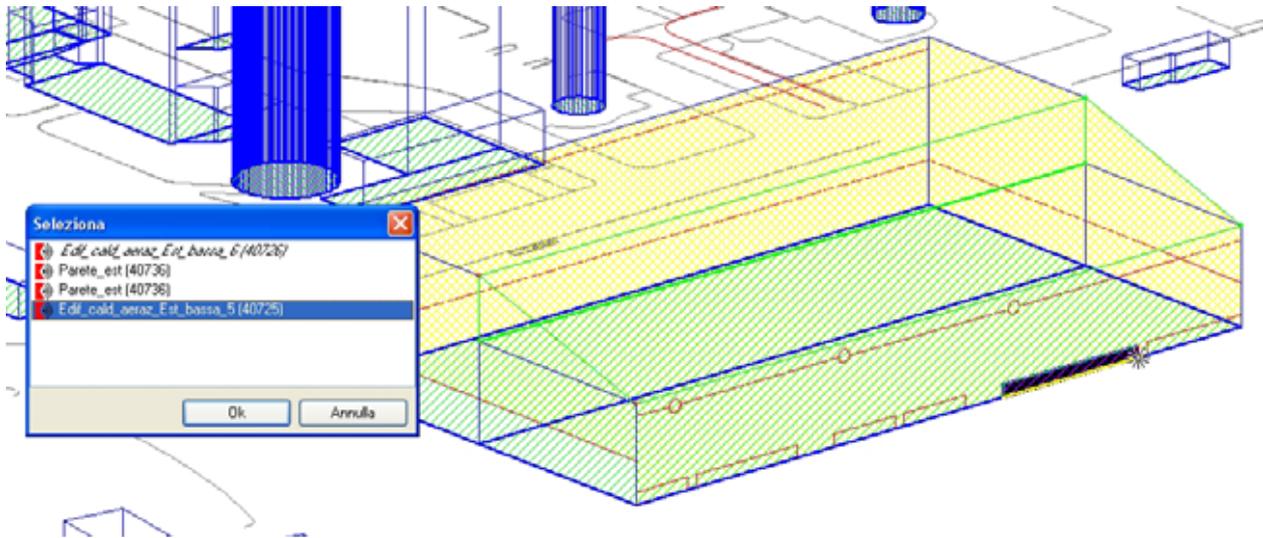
Nuovo edificio generatori di calore, porzione 5 ventilazione parete Est.
